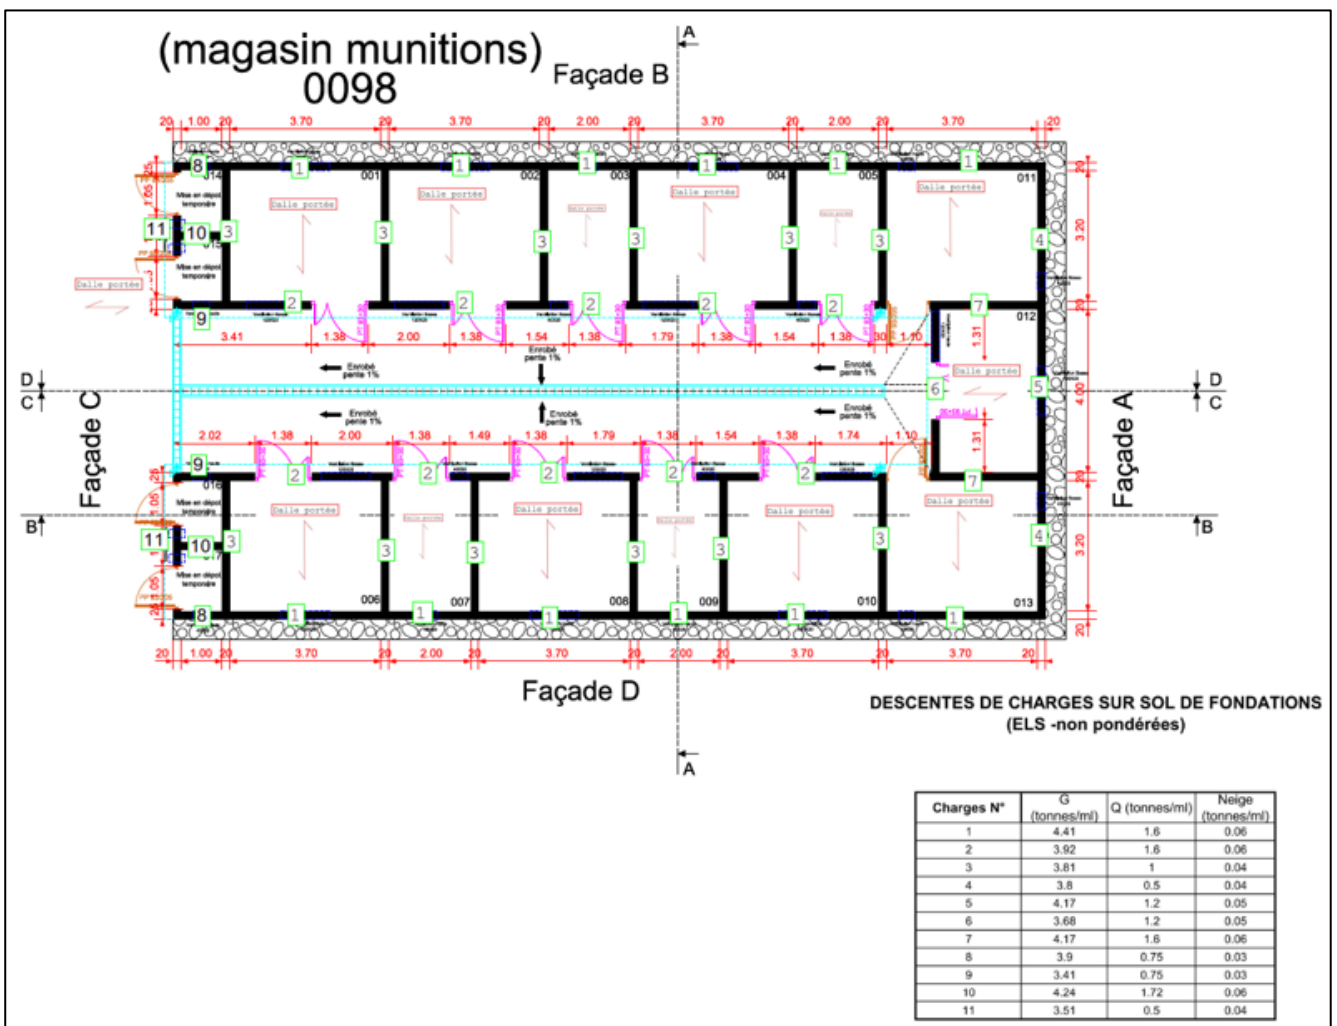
Plan de fondations avec DDC (échelle graphique)
